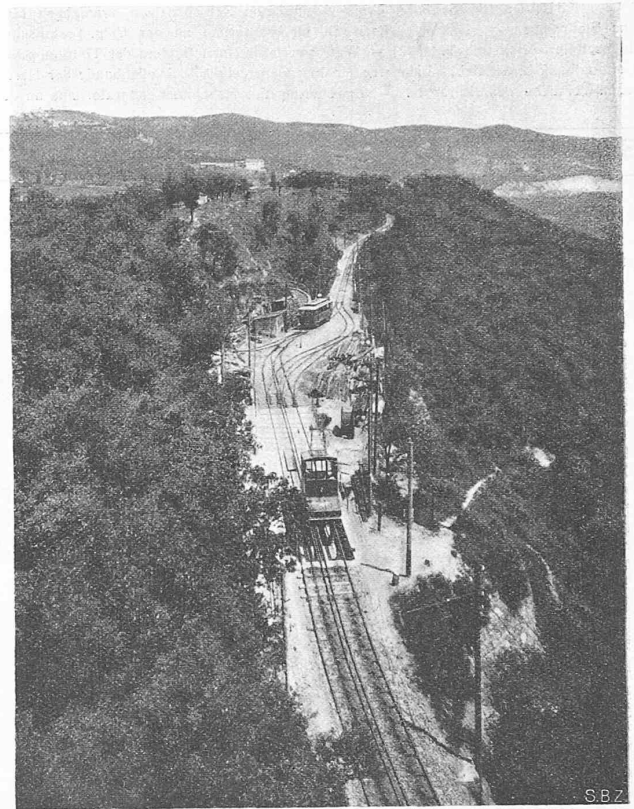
Oberes Seilbahn-Ende mit Anschlussgeleisen.
